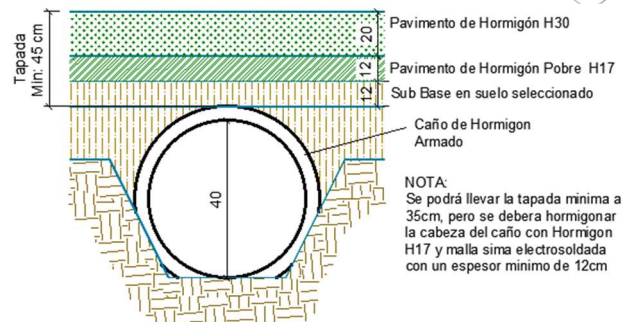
Detalle de alcantarilla - forma parte de los planos anexos en escala ampliada
